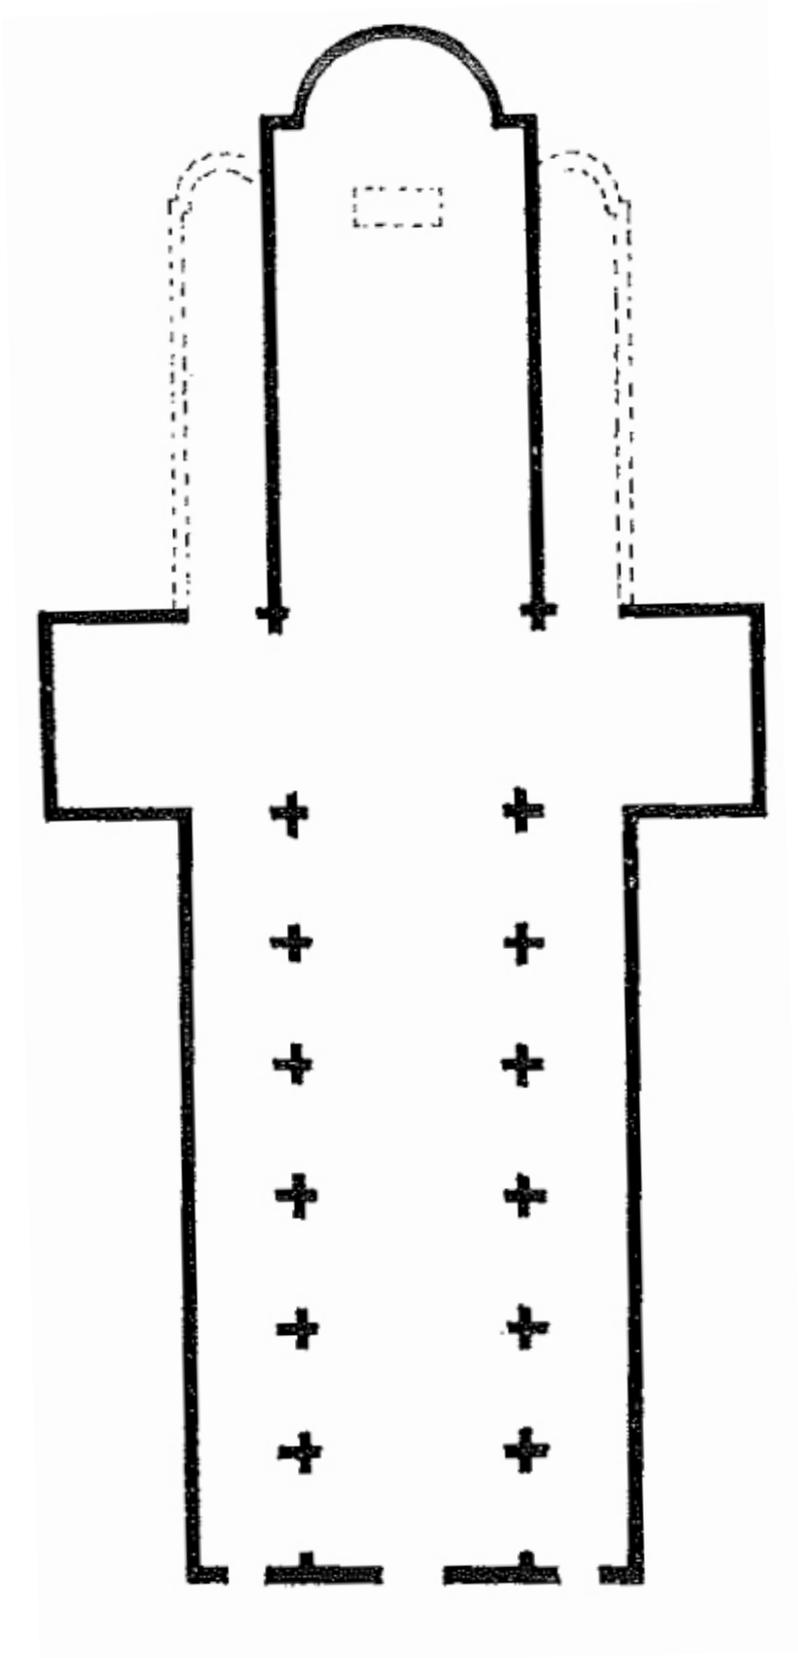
Reggio Calabria, antica Cattedrale, pianta
